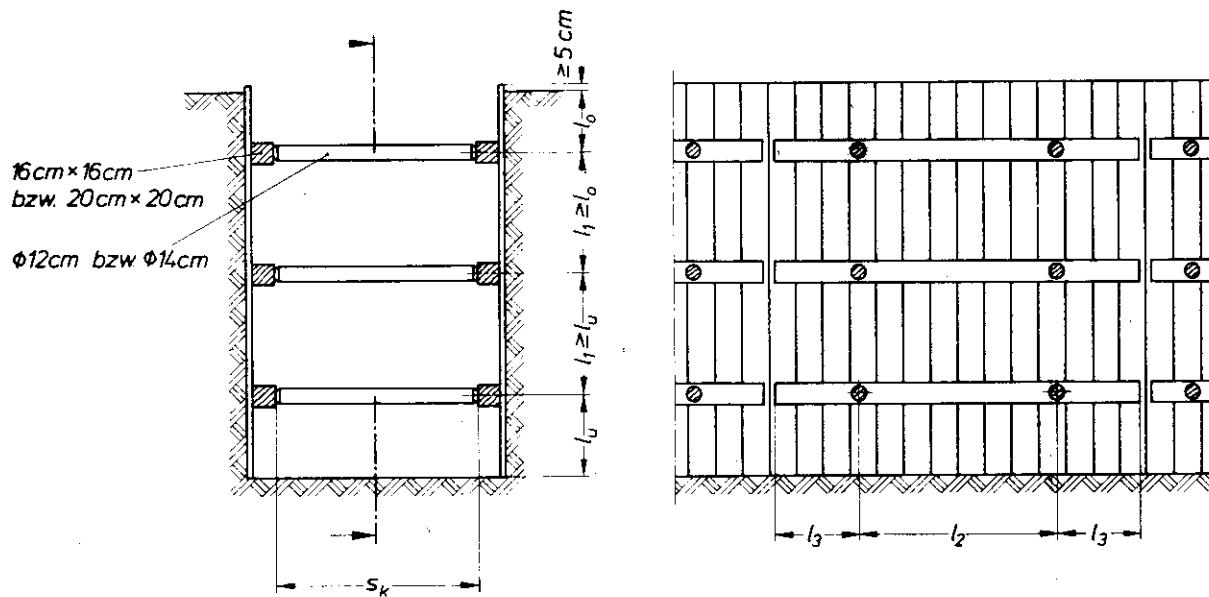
Senkrechter Normverbau mit Verbauteilen aus Holz (ohne Darstellung der Befestigungsmittel)
